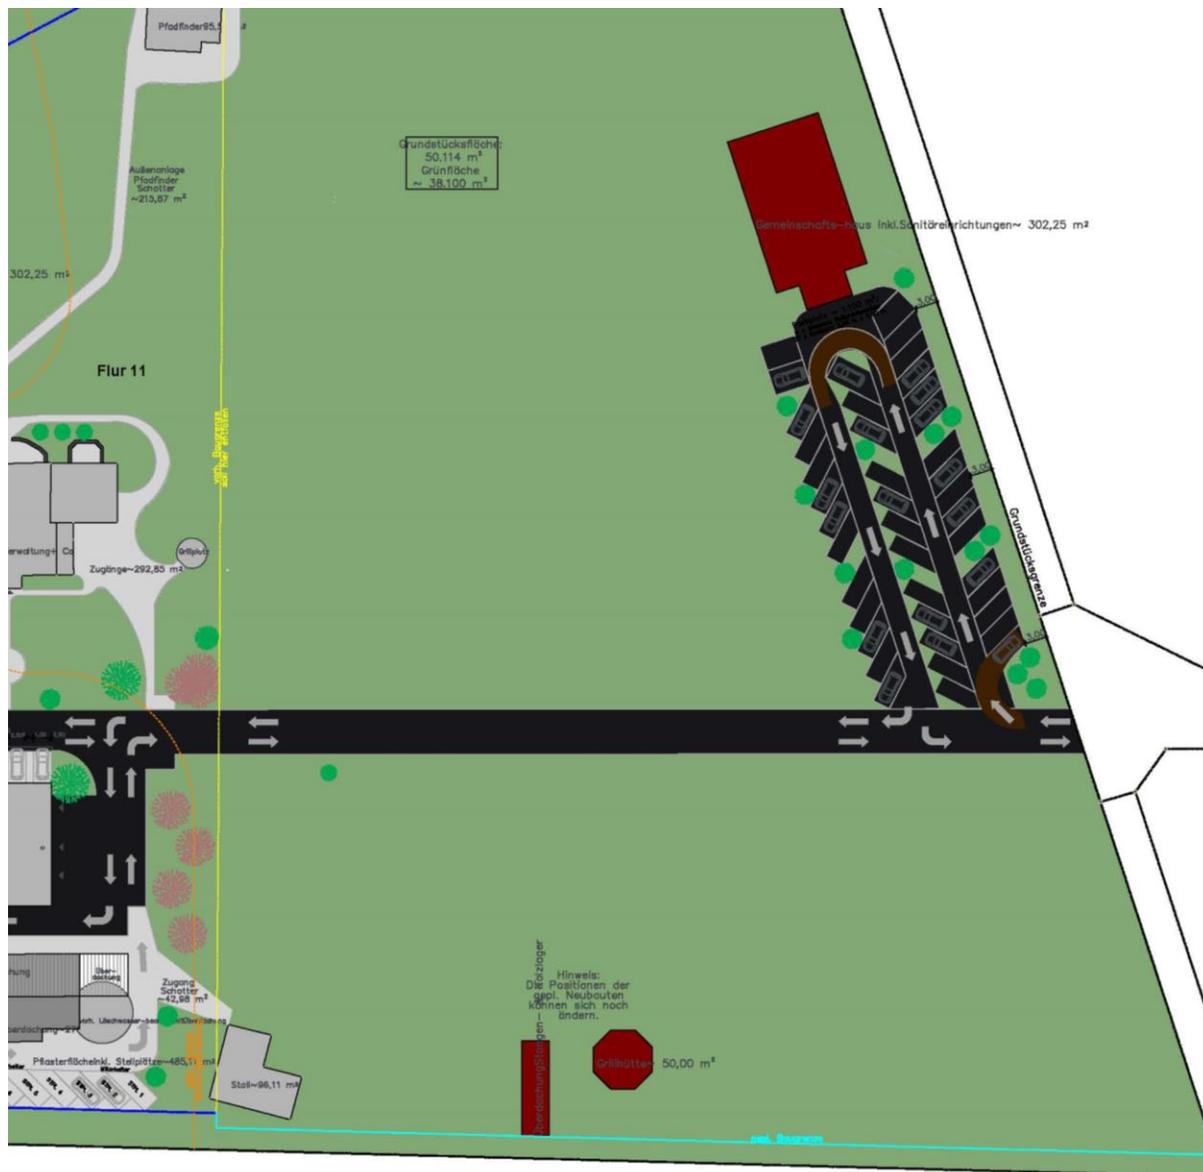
Geplante Baumaßnahme im Bereich Sondergebiet Pfadfinder (Gebäude für Küche, WC, Waschräumen mit Gruppen- und Lagerraum sowie Grillhütte und Stellplätzen), Auszug aus Fachplanung KDREI Ingenieure und Architekten, Dillenburg, Stand September 2022
